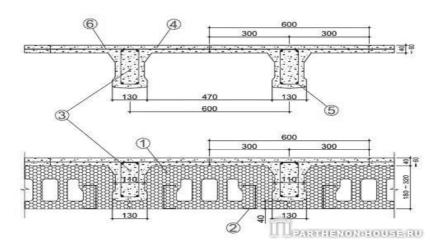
Ребристое перекрытие, созданное с использованием несъемной опалубки: 1 - несъемная опалубка перекрытия; 2 - оцинкованный стальной U-профиль; 3 - железобетонные ребра перекрытия; 4 - железобетонная плита перекрытия; 5 - рабочая арматура ребер; 6 - арматура плиты.
